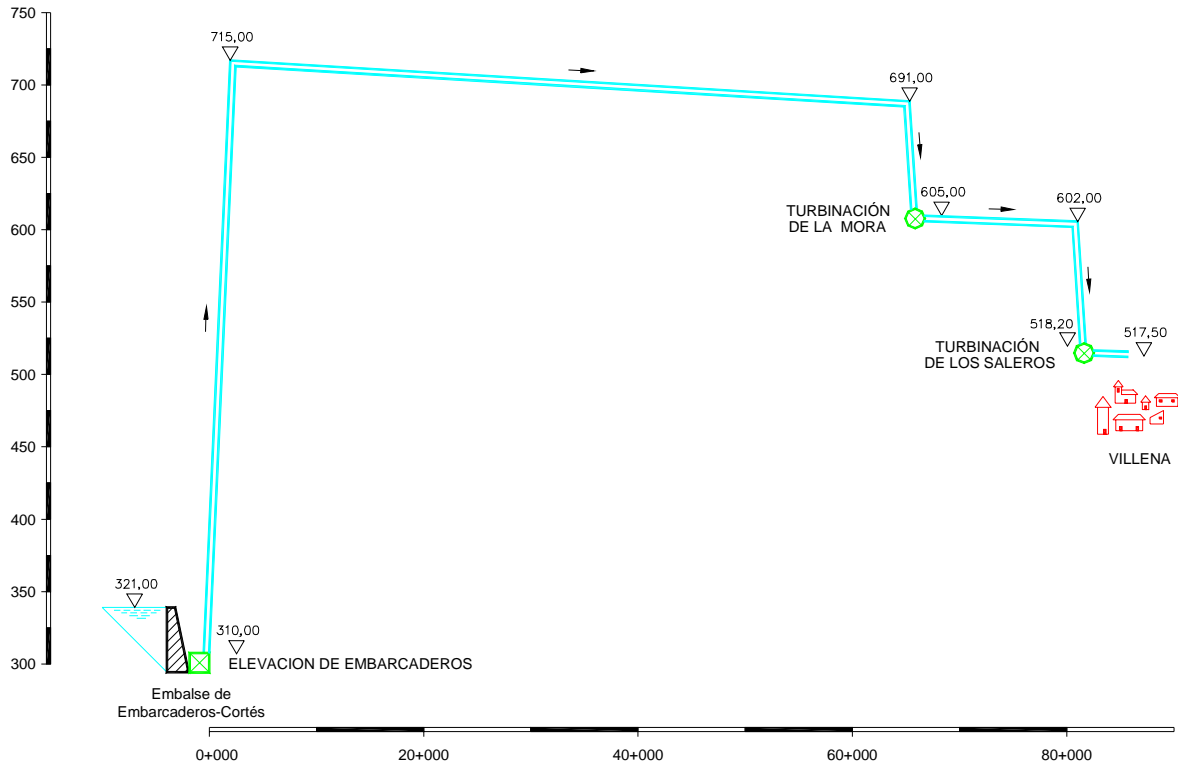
Conducción Embarcaderos - Villena. Esquema en alzado
